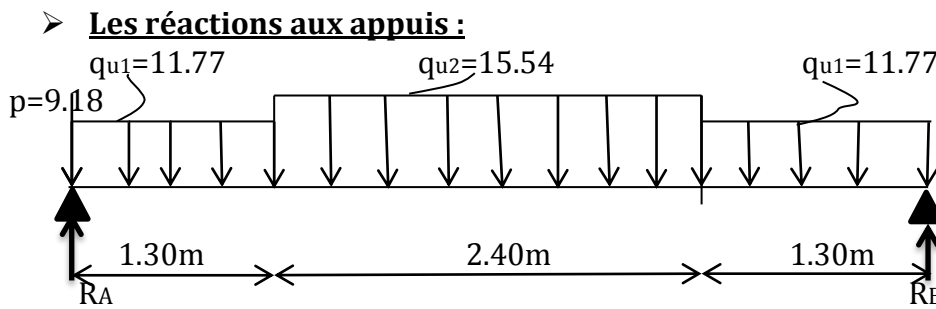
Schéma statique d'escalier a l'ELU.
